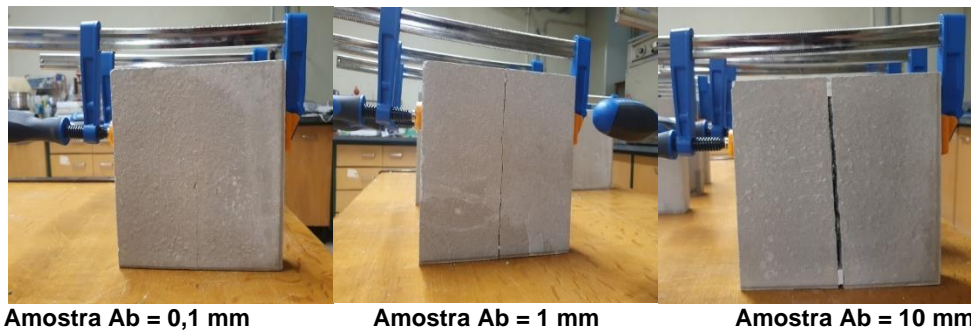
Lajetas com as fissuras artificiais após fixação com grampos (aberturas 0,1, 1 e 10 mm).
